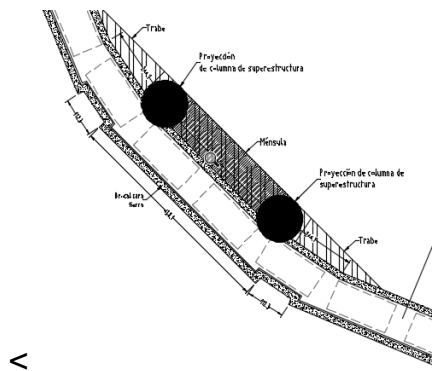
Vista en planta de la posición de las ménsulas y las trabes.⁴⁷
